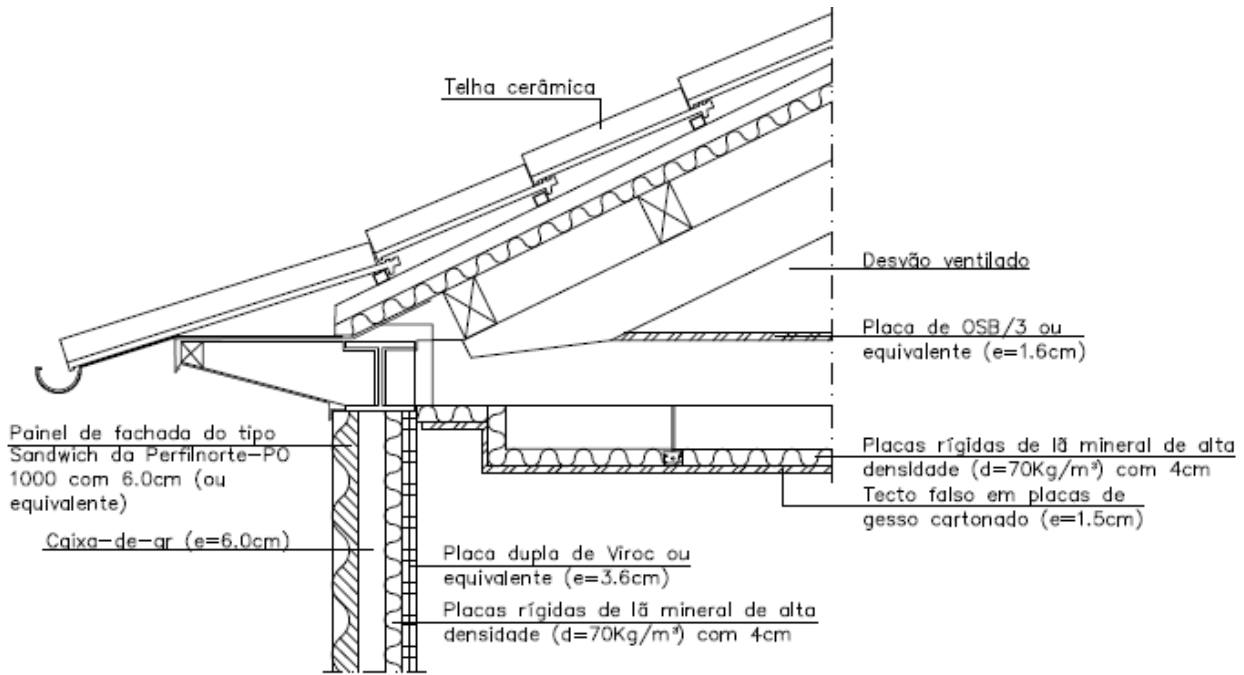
Pormenor da cobertura e teto do 4º piso (recuado) [19]
